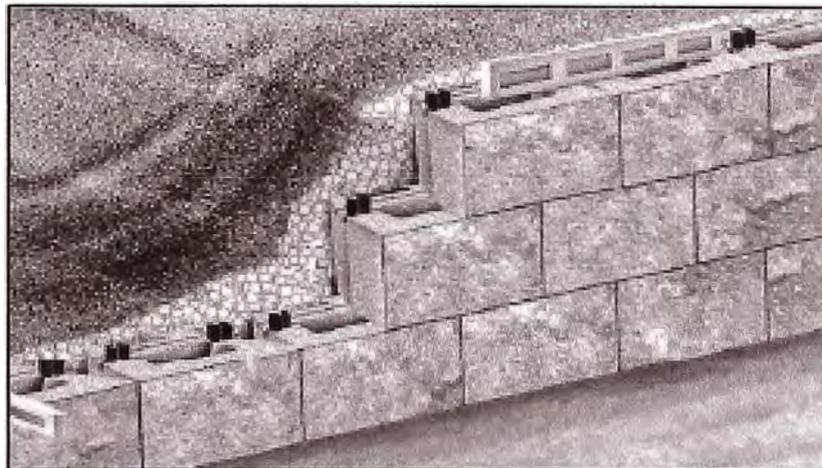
Muro de suelo reforzado – Colocación de Filtro.
